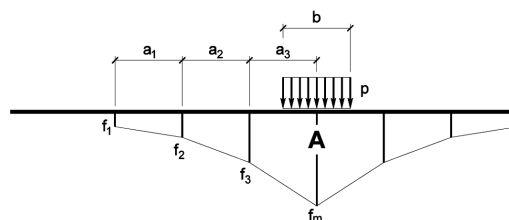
Schema di posa del carico di collaudo. Diagram of laying out of test load.
